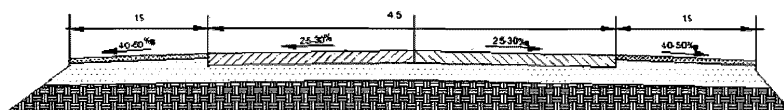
Покрытие – железобетонные плиты; основание – песчаный подстилающий слой; обочины – местный каменный материал
